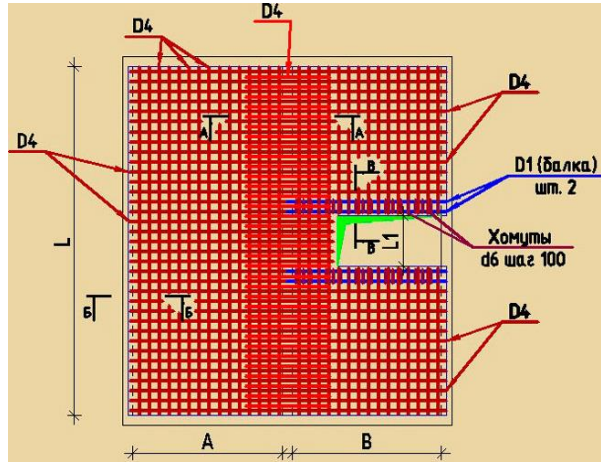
Схема розкладки арматурних стержнів по шаблону
